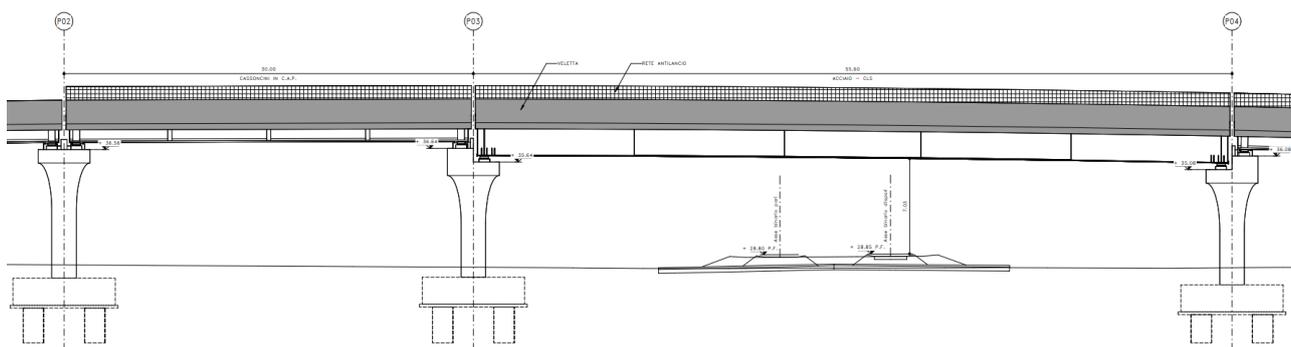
Prospetto degli impalcati in c.a.p. e struttura mista
